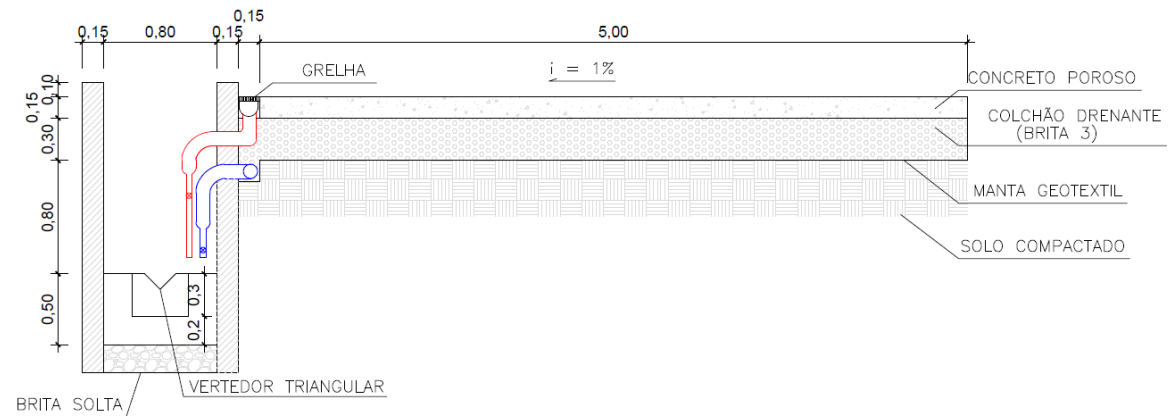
Corte BB – Perfil longitudinal do aparato de ensaio
